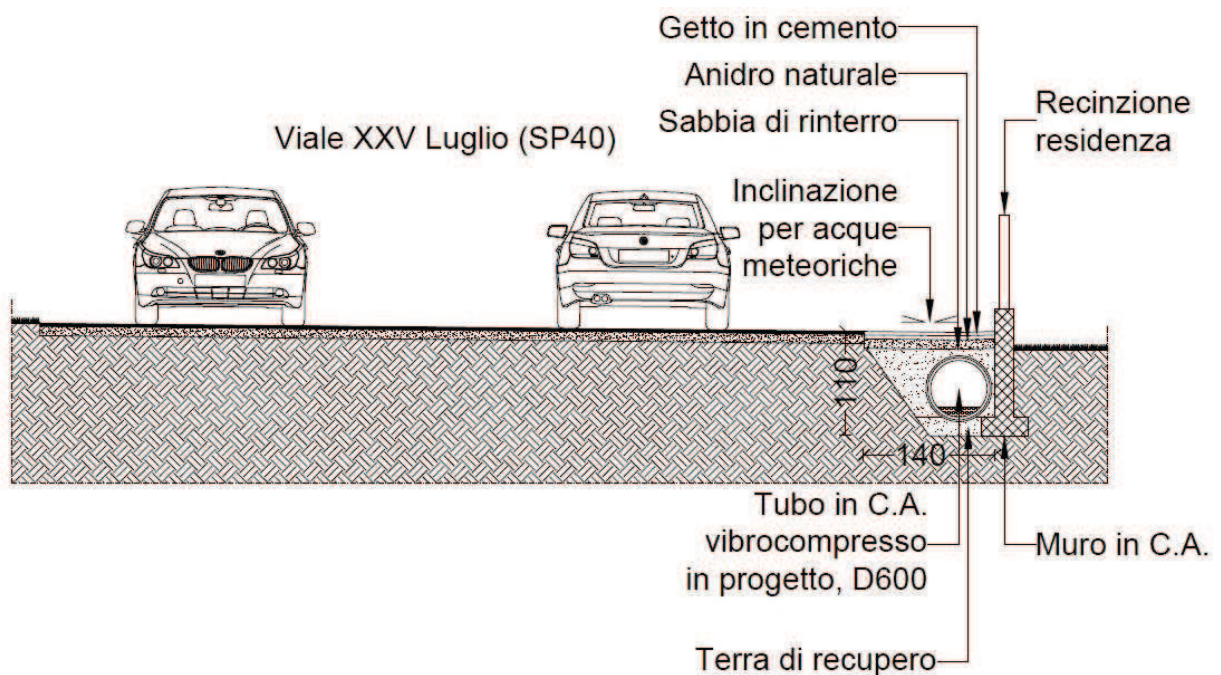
INTERVENTO 1- Sezione trasversale alla strada
